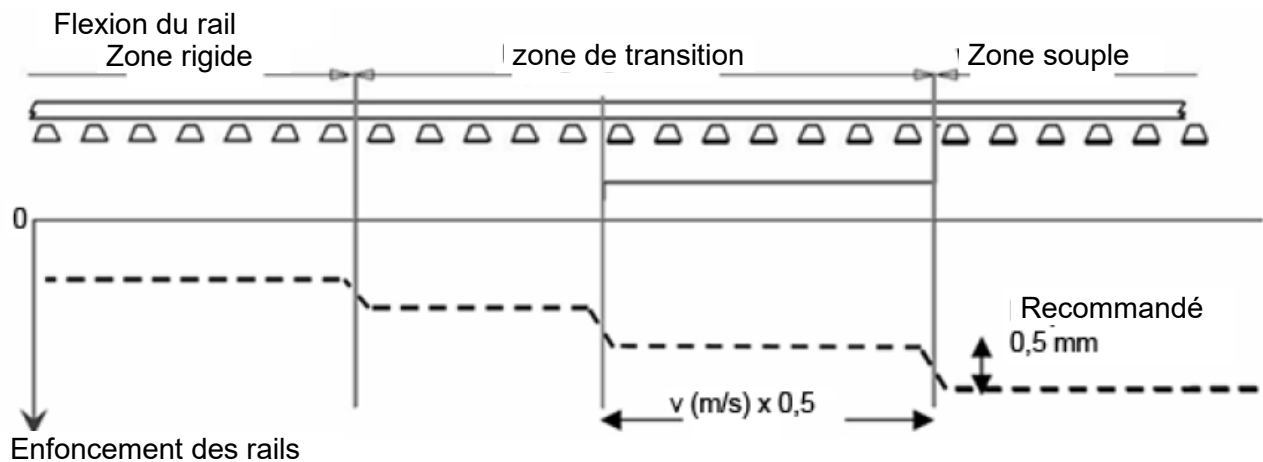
affaissement du rail au niveau d'une transition sur la voie ferrée [8]
